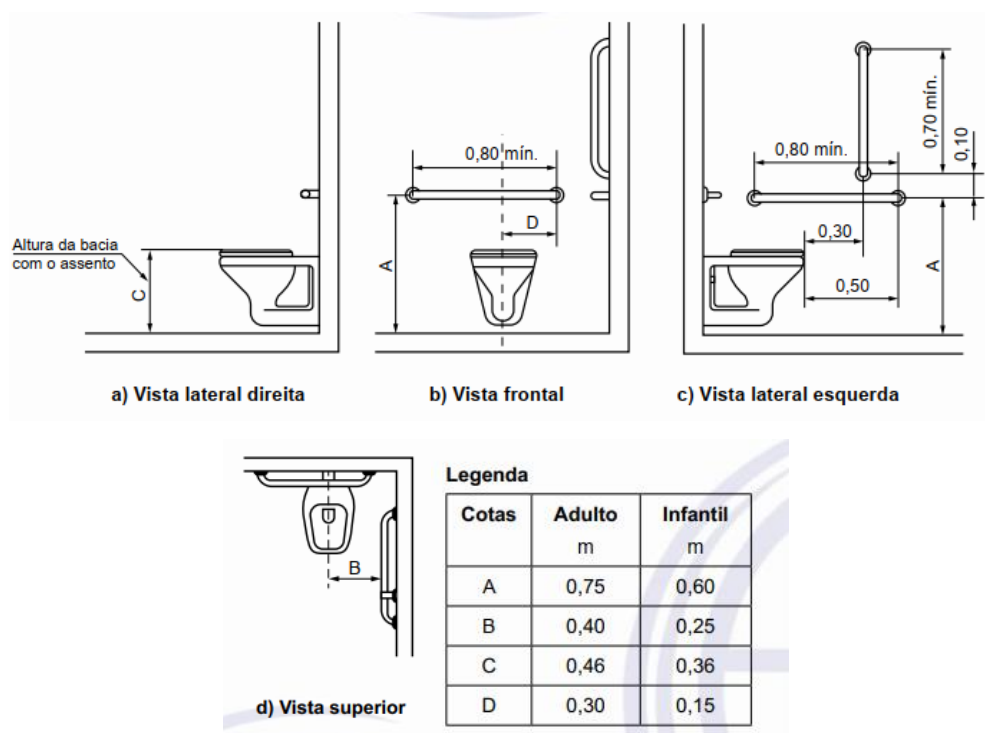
Bacia suspensa com barras de apoio ao fundo e a 90° na parede lateral -
